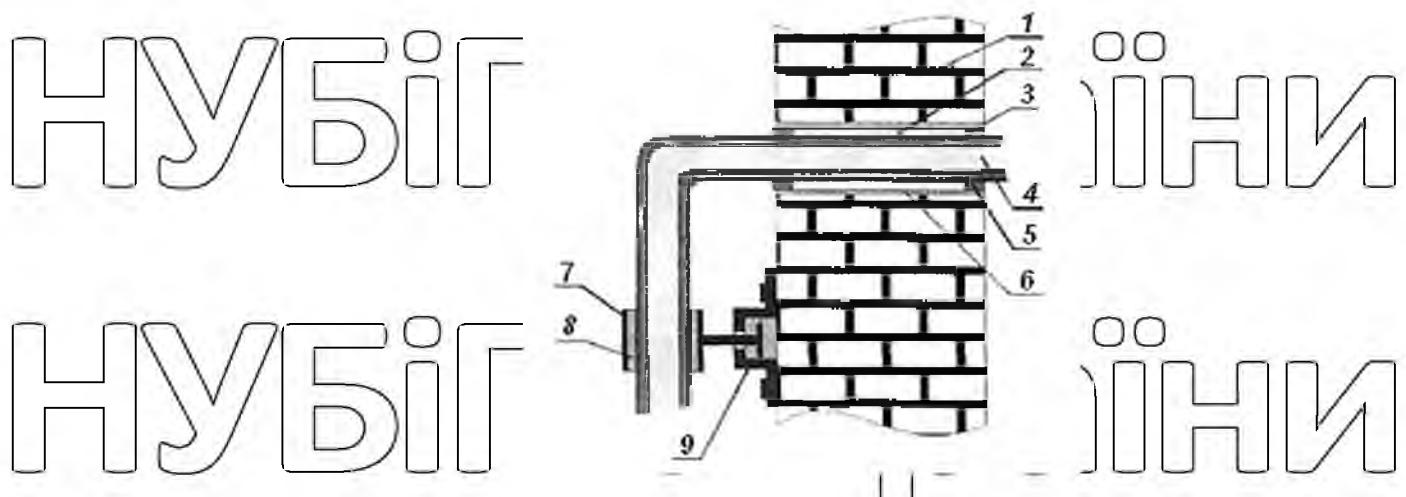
Віброізоляційна гільза: 1 – стіна; 2 – негорюча пружна прокладка; 3 – віброізоляючий матеріал; 4 – трубопровід; 5 – герметик; 6 – гільза; 7 – монтажний кронштейн; 8 – прокладка з м'якої гуми; 9 – віброізоляюче кріплення.
